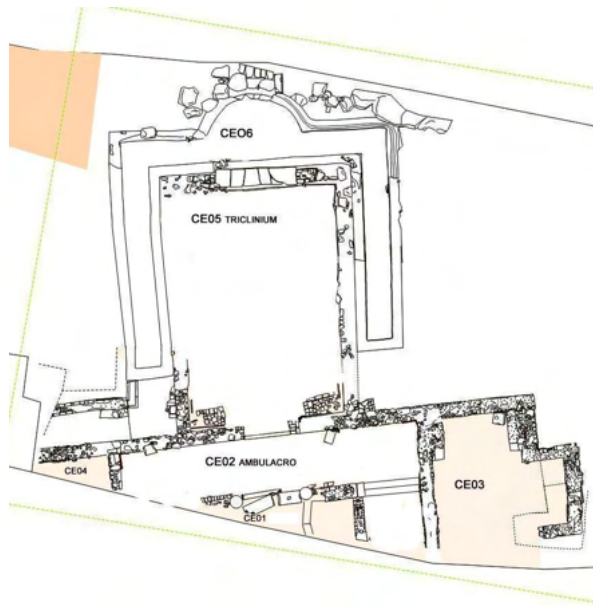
Planta de la excavación con Complejos Estructurales, en 2012 (Autor: Taouffik El Amrani).
